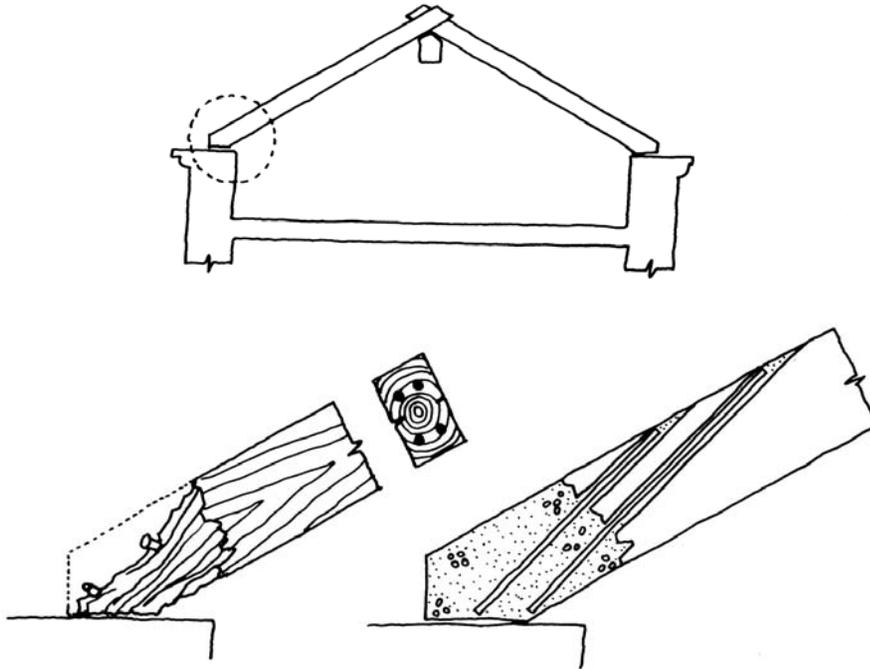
Consolidación del apoyo de un par mediante una prótesis de mortero epoxi conectado a la madera sana.
